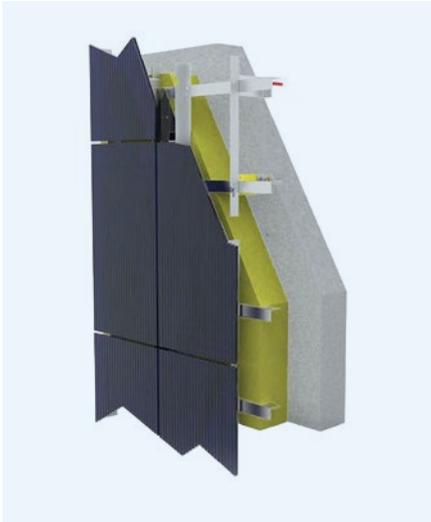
Konstruktiver Aufbau einer Fassadenanlage
